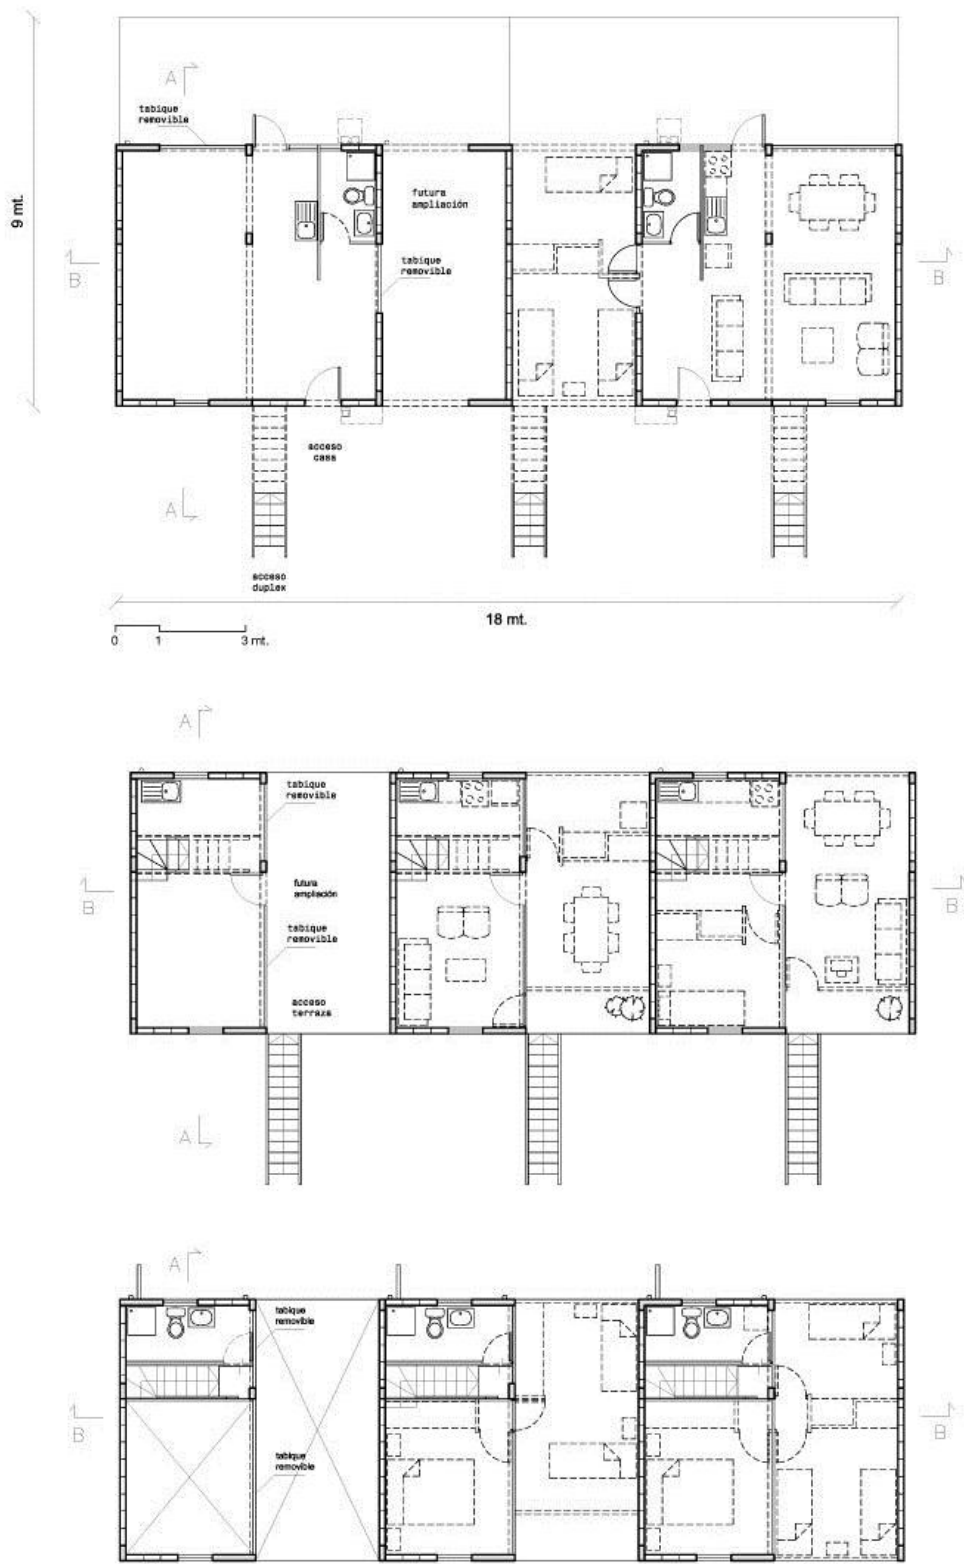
Planimetría de las diferentes tipologías y distribuciones.
